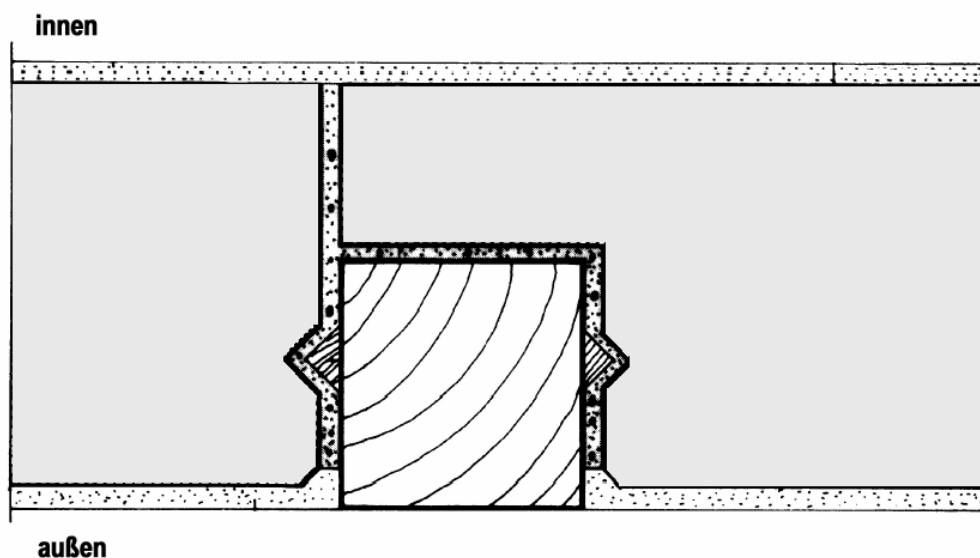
Innen überstehende Porenbeton-Plansteine als Gefach-Ausmauerung
